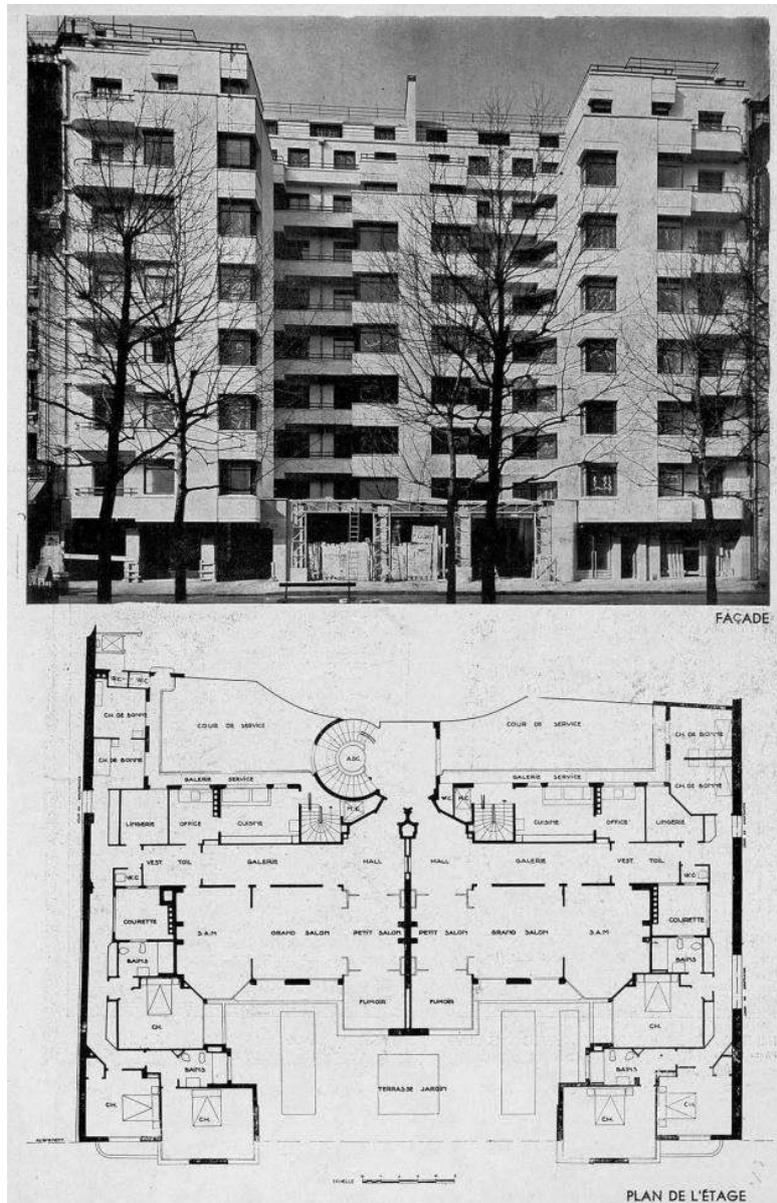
Planta tipo y fachada del inmueble de apartamentos del arquitecto Pol Abraham situado en el Boulevard Raspail. Paris, 1933. Fuente: (Abraham, 1933)
